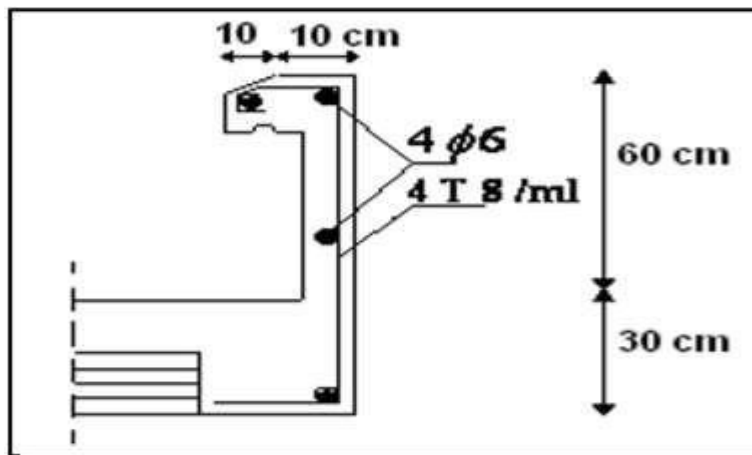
Coffrage et ferrailage de l'acrotère
